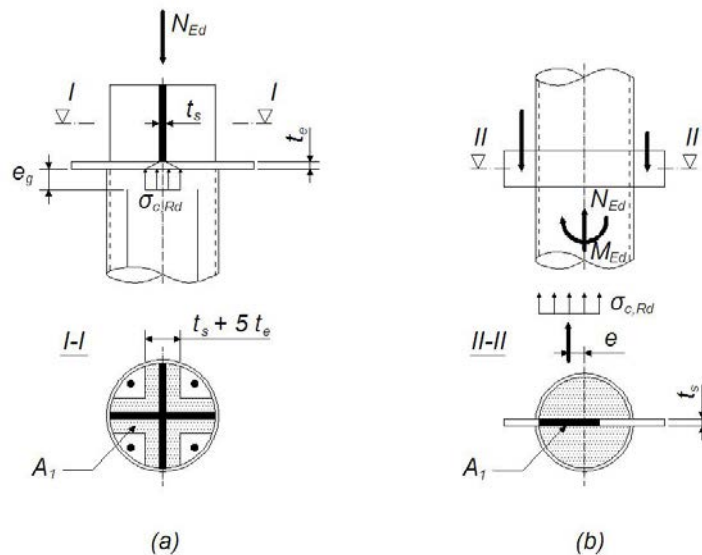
Частково навантажене кругле порожнистий перетин, заповнений бетоном
